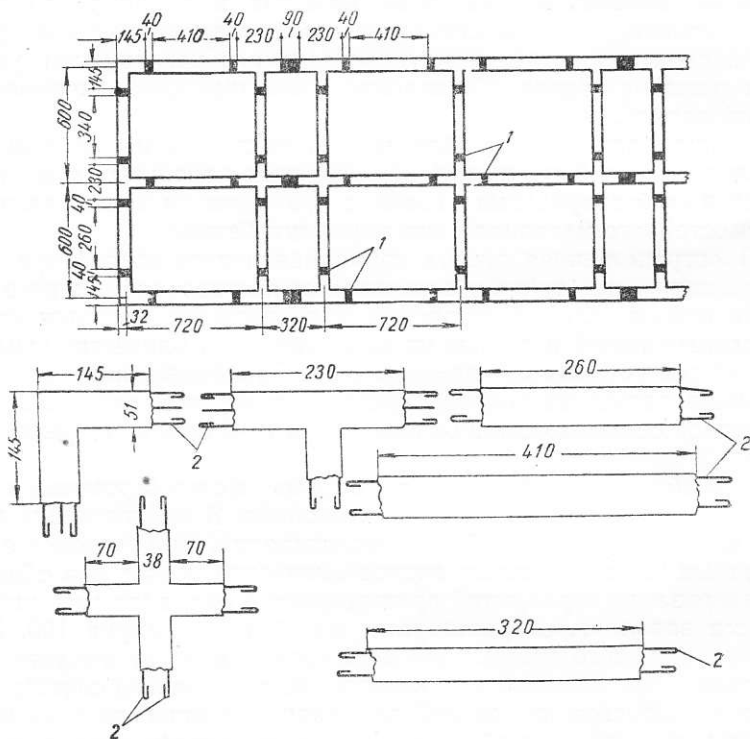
Схема стыков сборного железобетонного антисейсмического пояса
